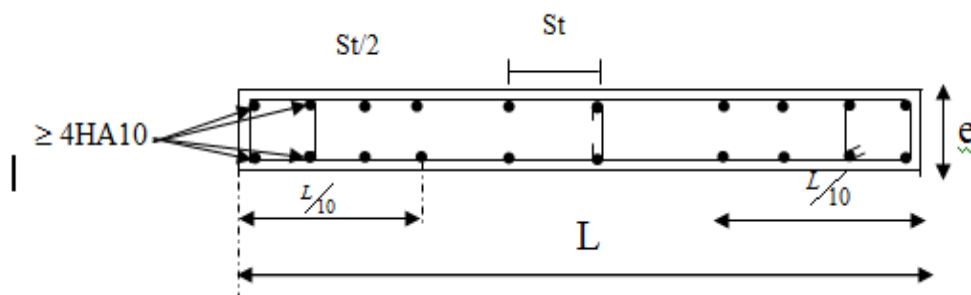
Disposition des armatures verticales dans les voiles.
